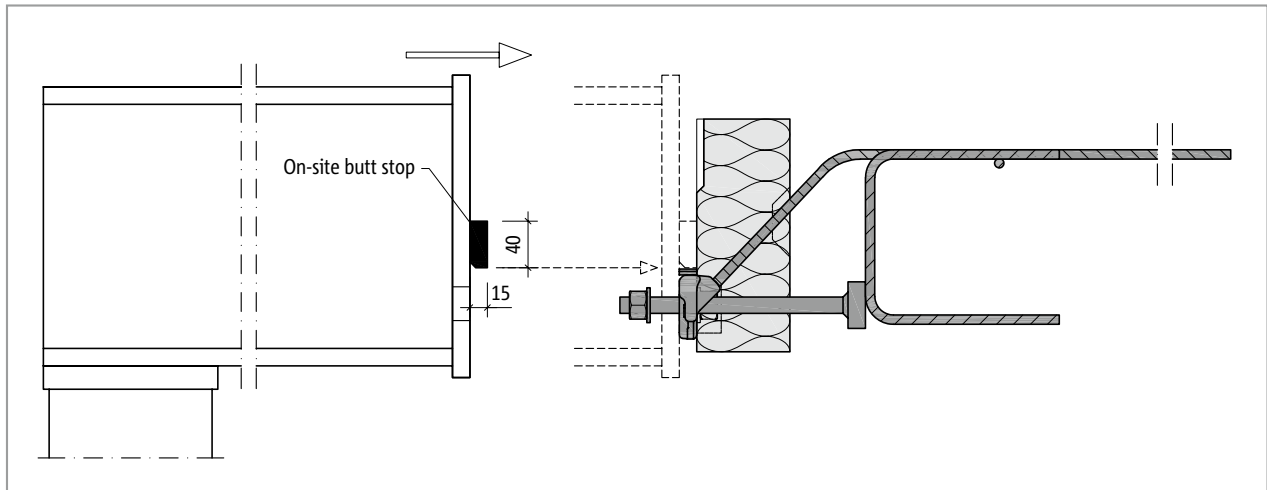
Schöck Isokorb® T type SQ: Mounting the steel member
